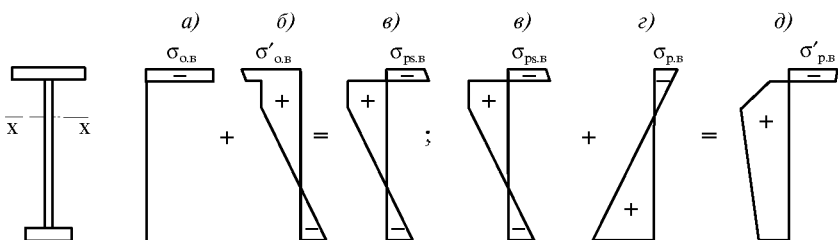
Эпюры нормальных напряжений в балке с предварительным пластическим деформированием стенки
